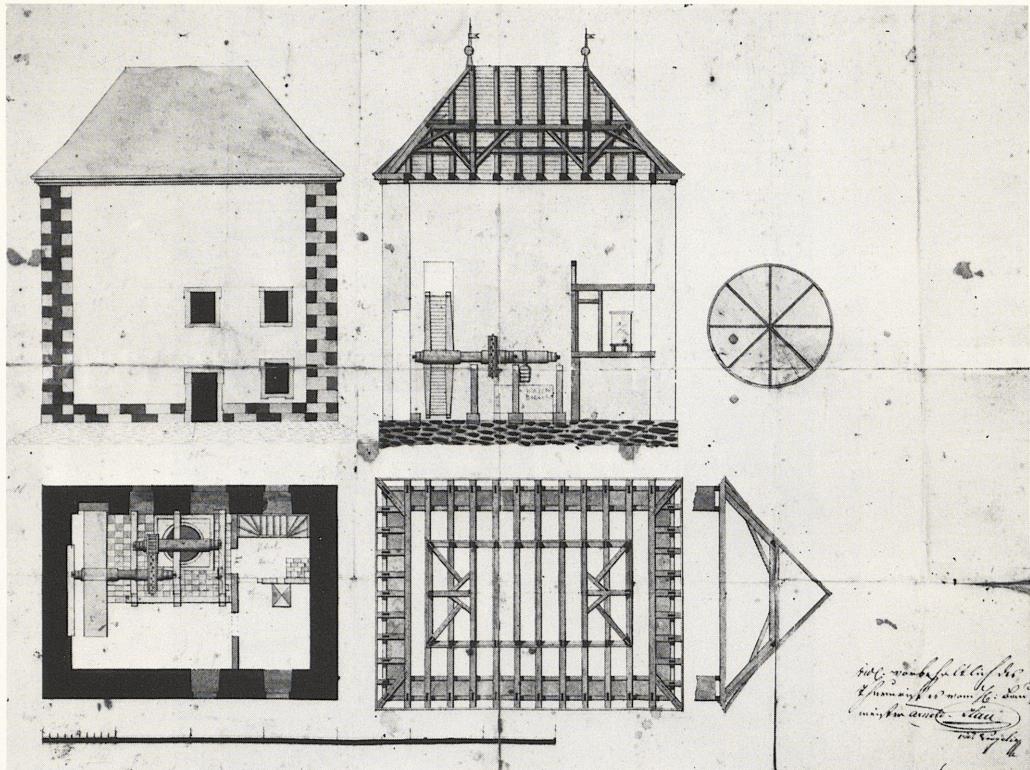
Umbauplan für den Radbrunnen. Oben links: Ostseite; oben rechts: Schnitt in S-N-Richtung; unten links: Grundriß mit Einbauten; unten rechts: Dachkonstruktion. (Stadtarchiv Freiburg L 1 Breisach B 1238)
